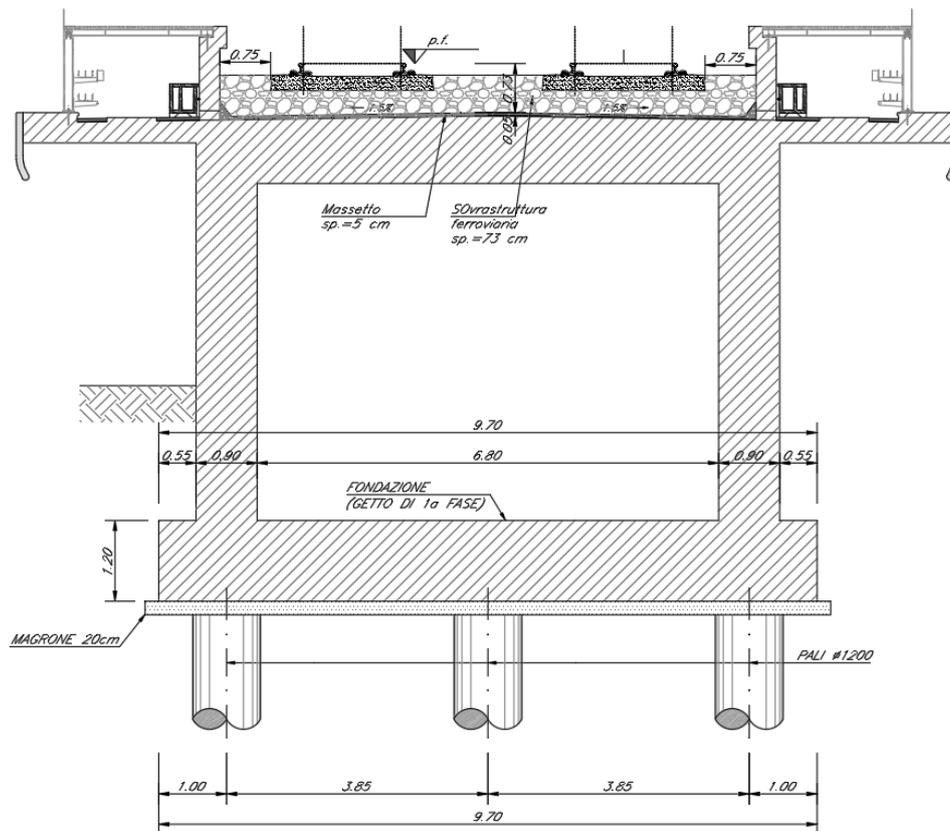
Sezione tipo del manufatto senza setto trasversale
